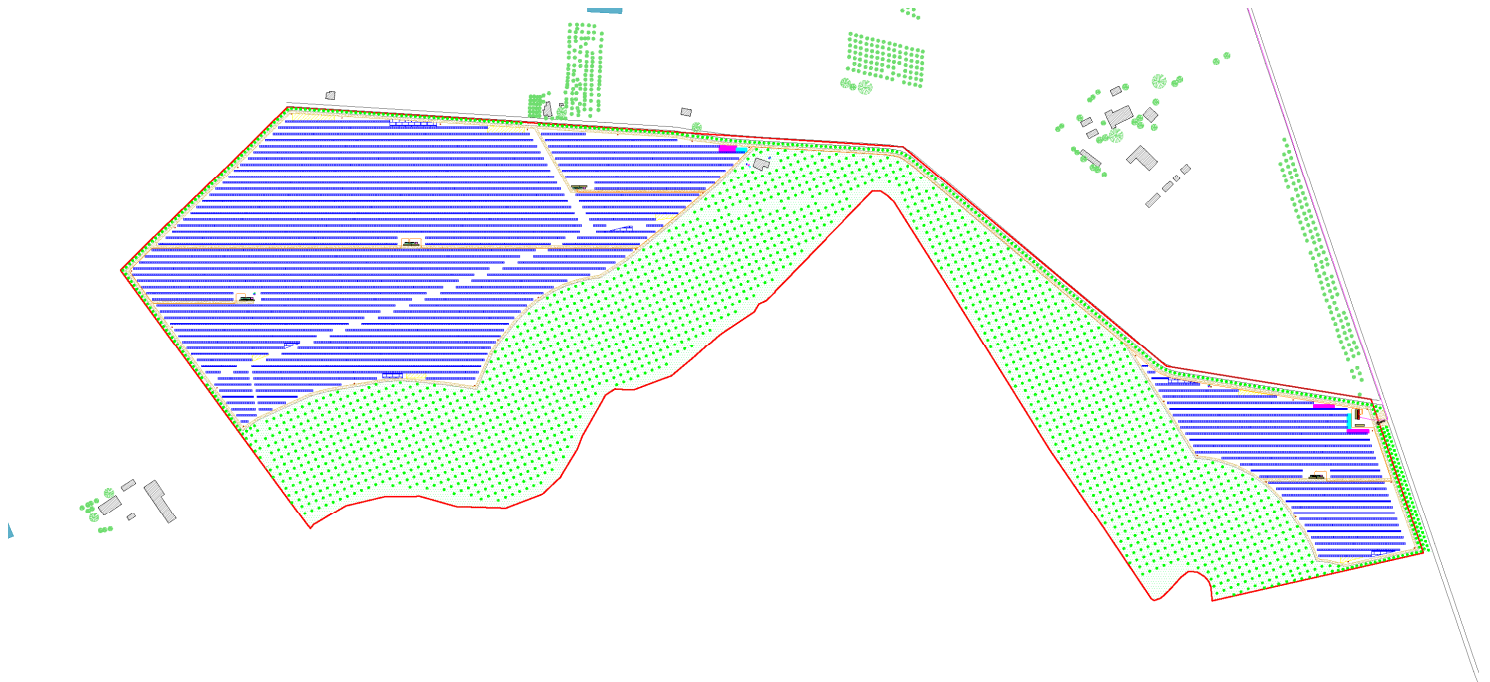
Piano di cantierizzazione con individuazione dei punti di stoccaggio e delle aree di cantiere sul Plot 1 (Tavola D25)
